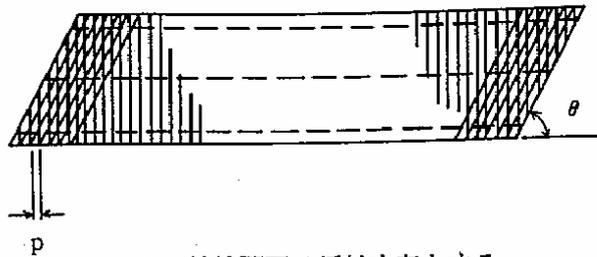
主鉄筋の配筋方向 (直橋の場合)
